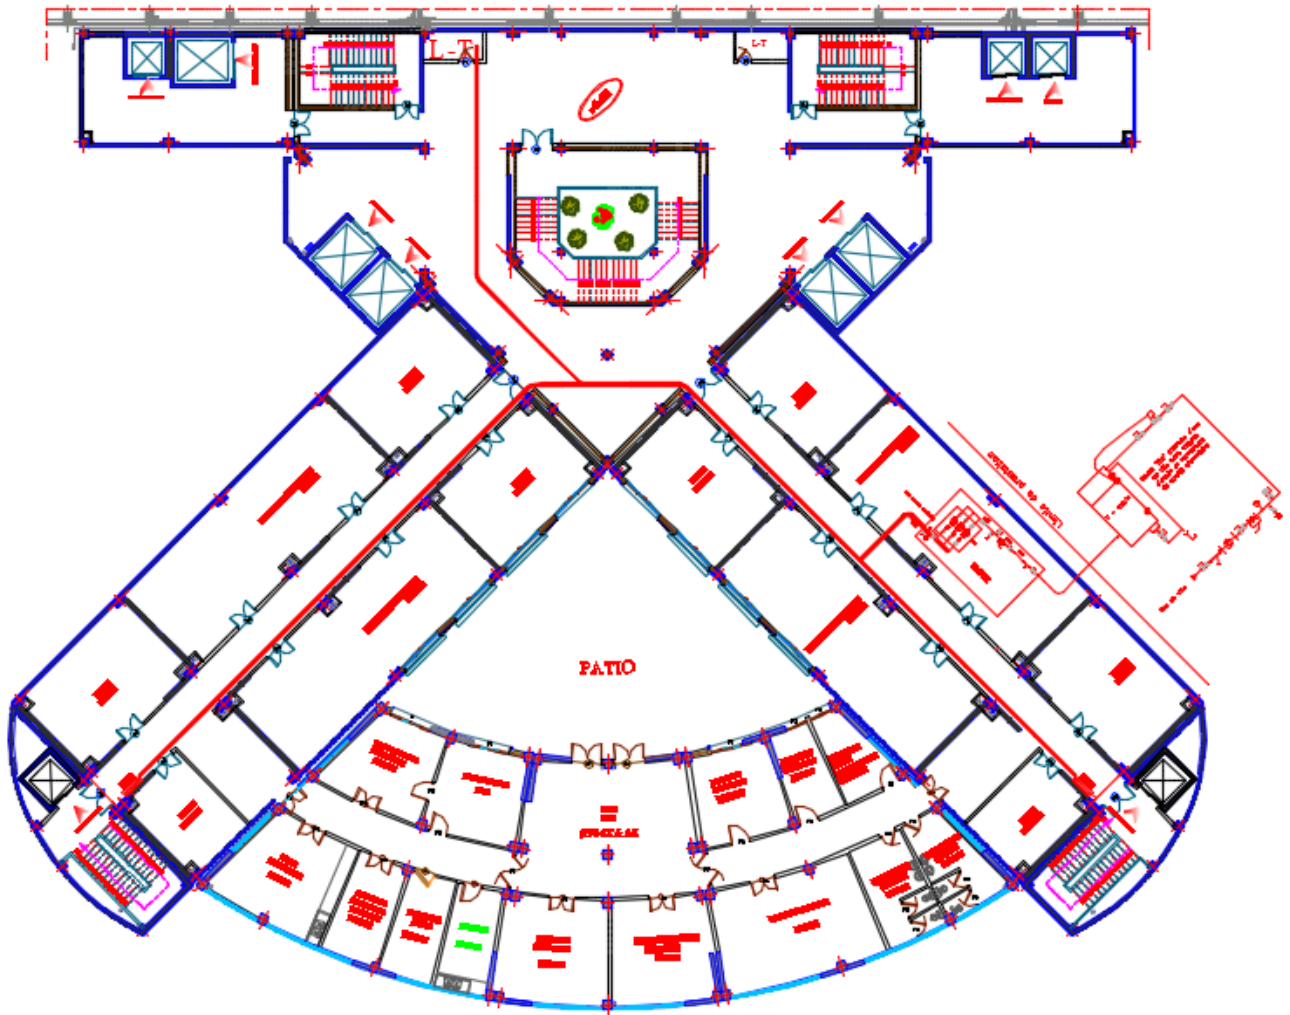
plan architectural de sous-sol qui nous montre le réseau RIA sur le niveau
